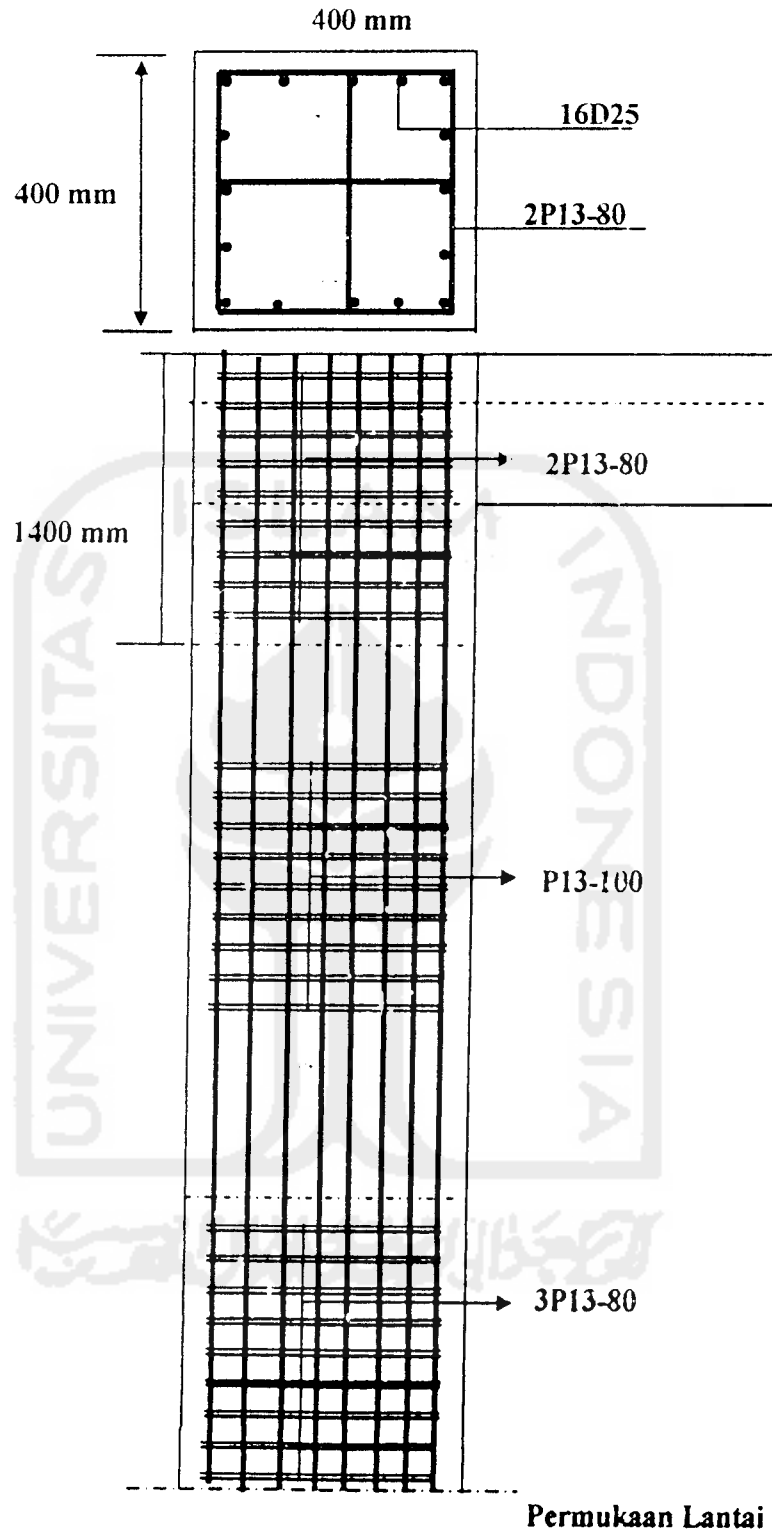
Detail Penulangan kolom Basemen-Lantai I
